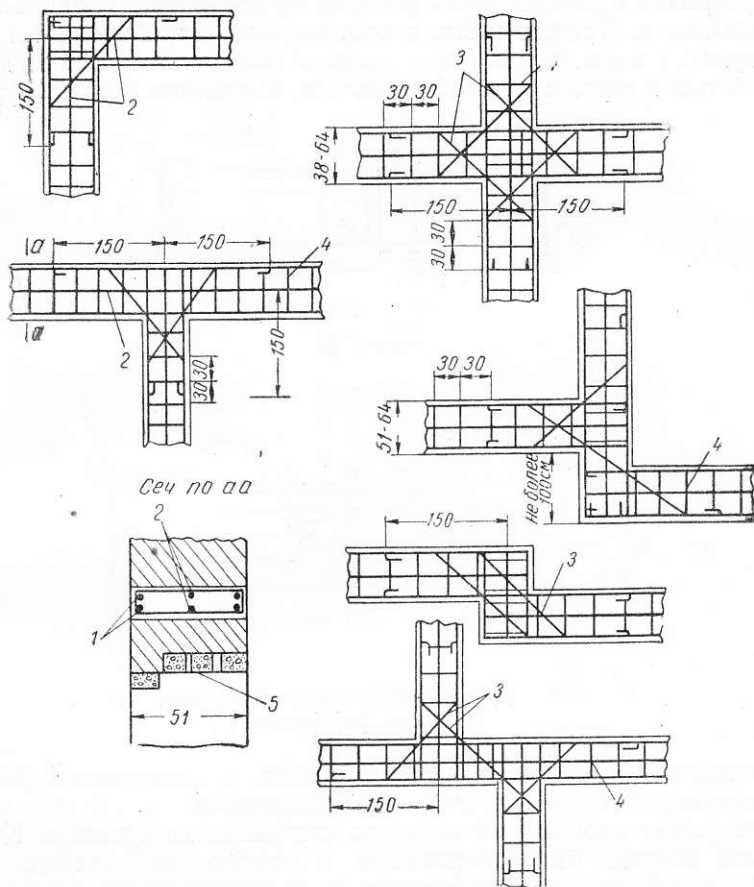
Армирование антисейсмических поясов в местах сопряжения стен
